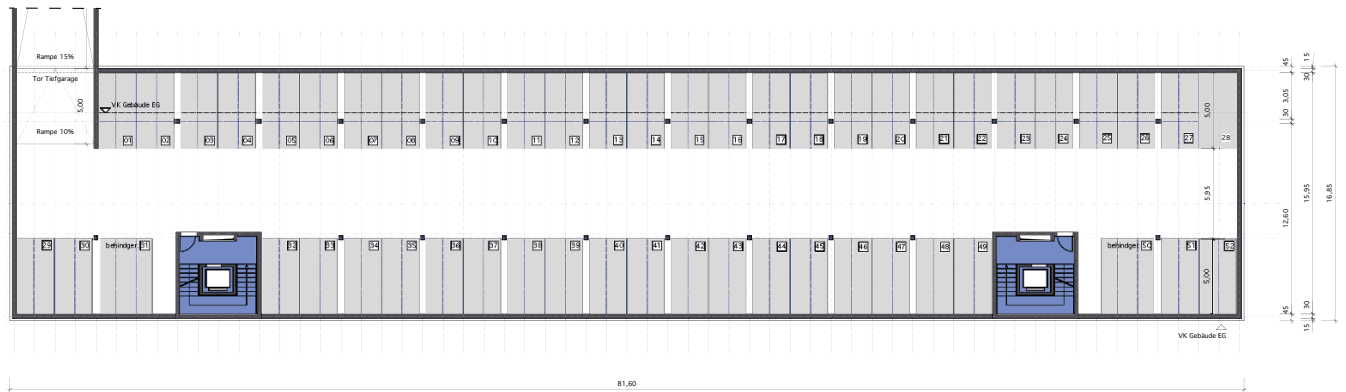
Grundrisse Referenzgebäude „geringe Variabilität“ für eine Hotelnutzung
